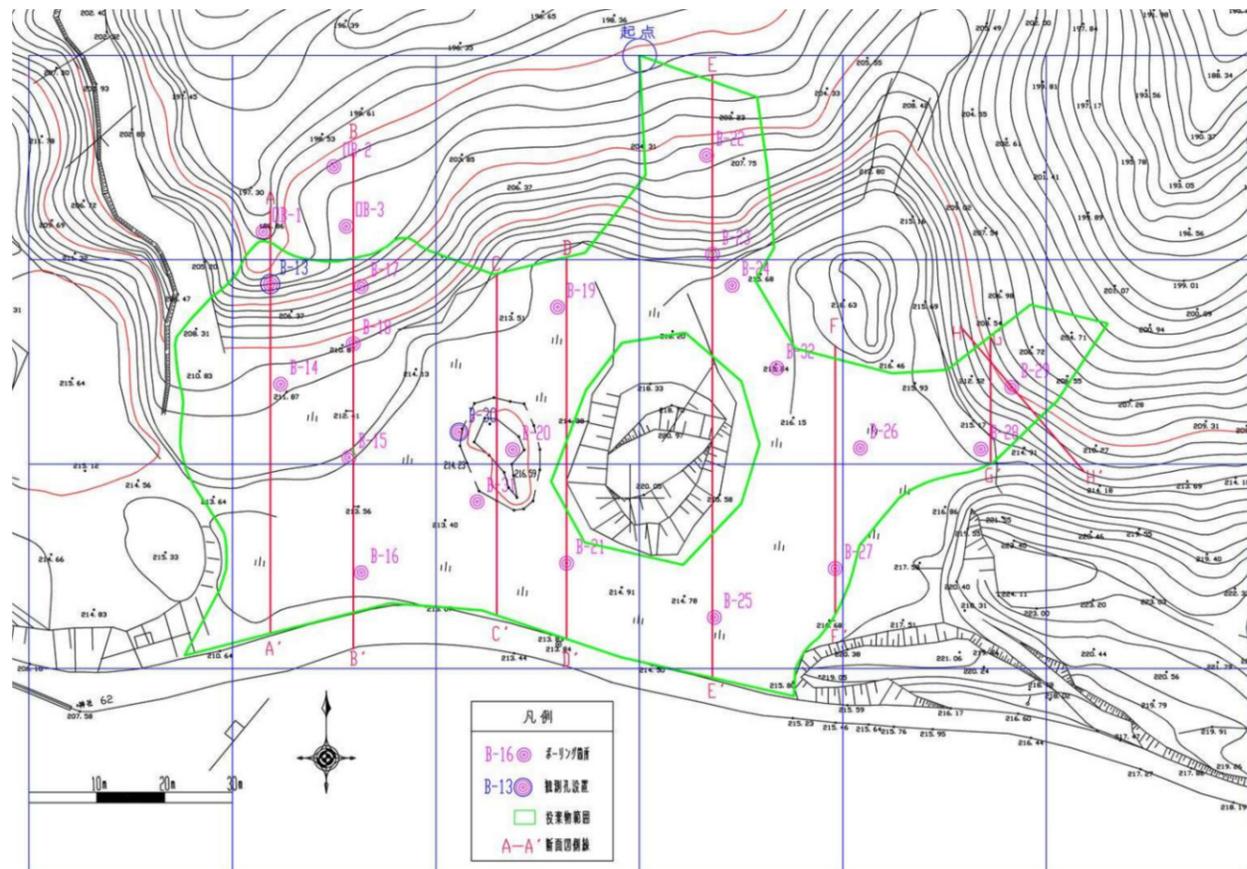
調査位置及び断面位置平面図 (縮尺任意)
